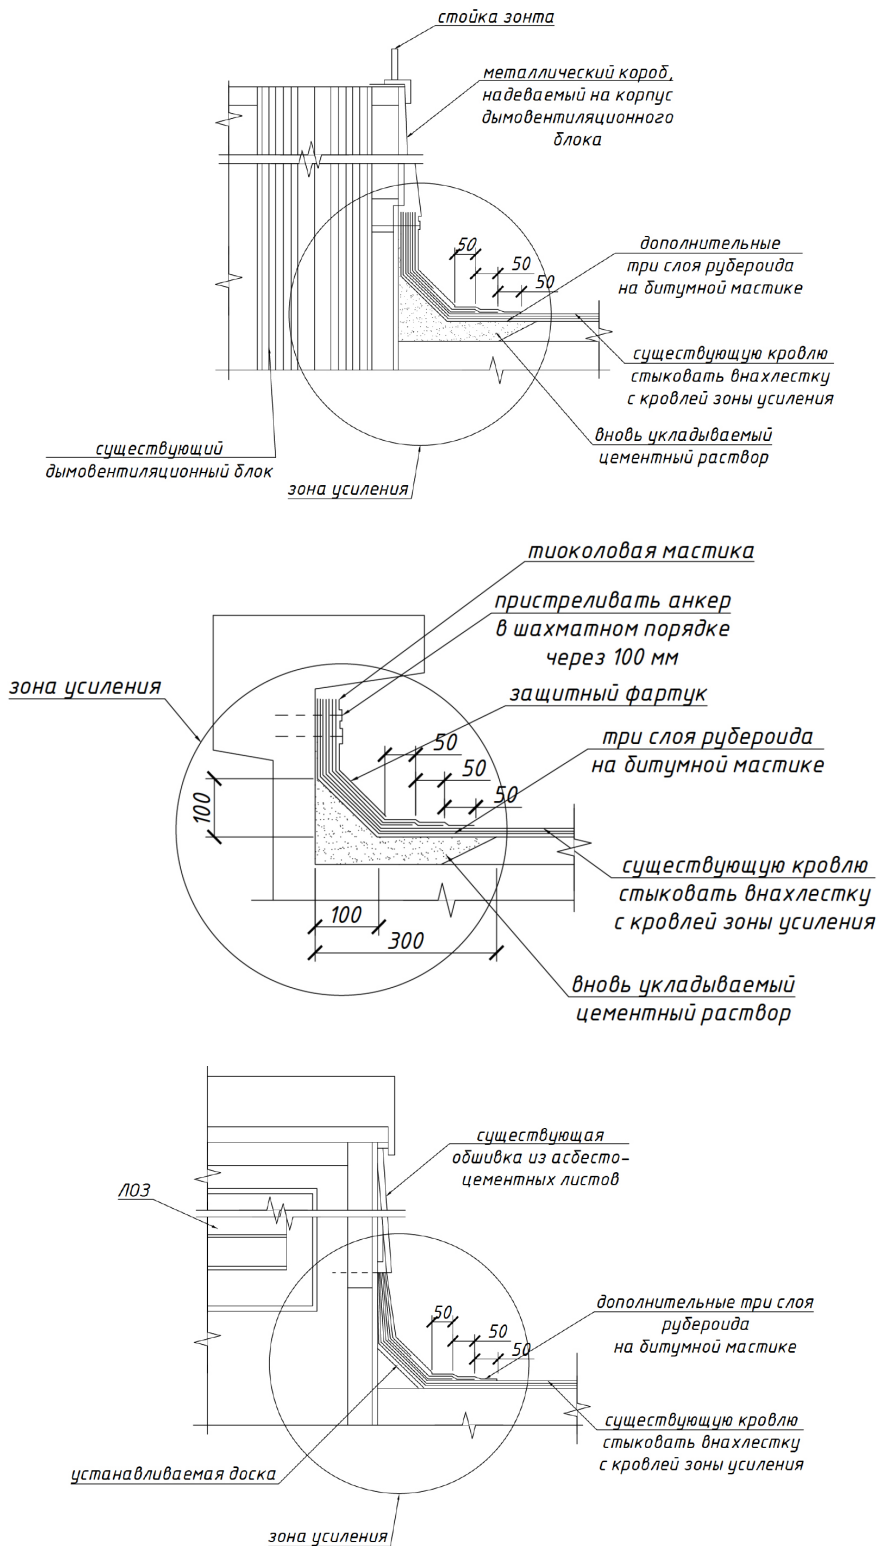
, начало. Примыкание кровли к лазу и дымовентиляционному блоку
